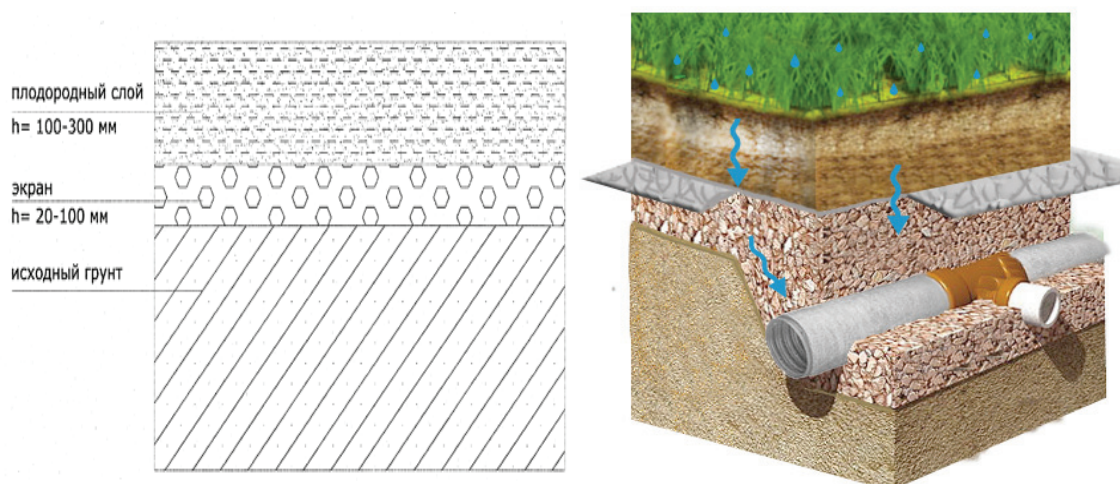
Схема сплошной почвенной конструкции для устройства газонов
